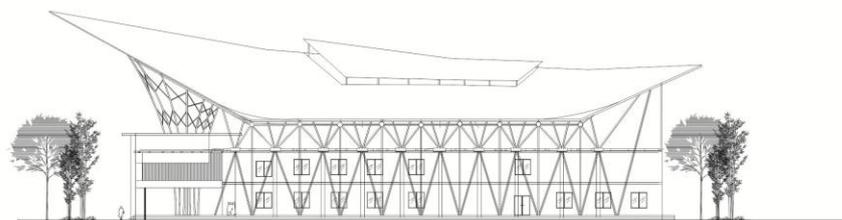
Hasil Rancangan Bangunan Konstruksi
